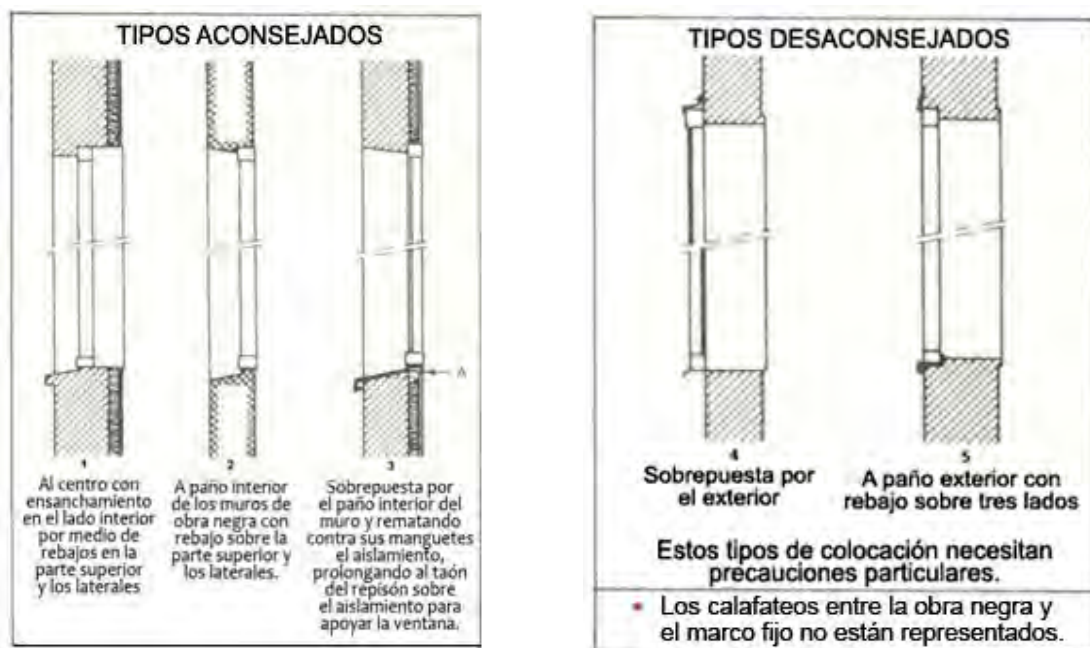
POSICIONAMIENTOS DE LAS VENTANAS DENTRO DEL ESPESOR DE MUROS DEL VANO
